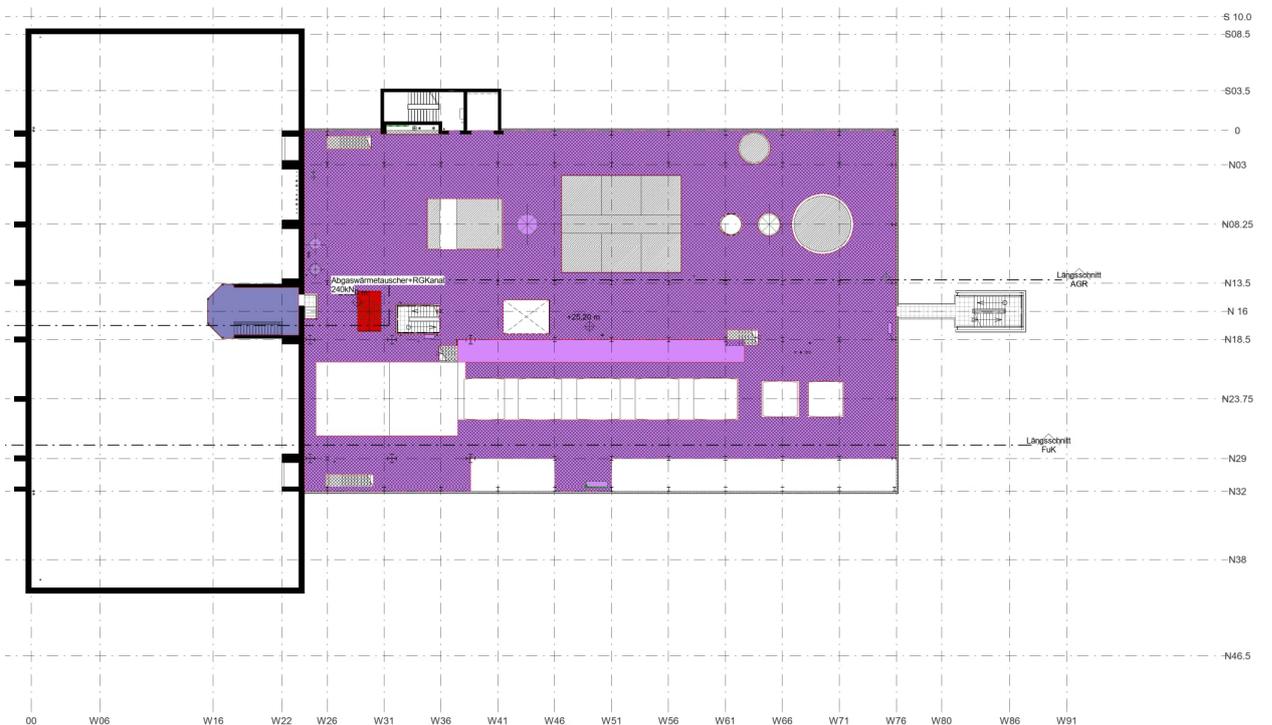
Nutzlasten Grundriss +25.20m
